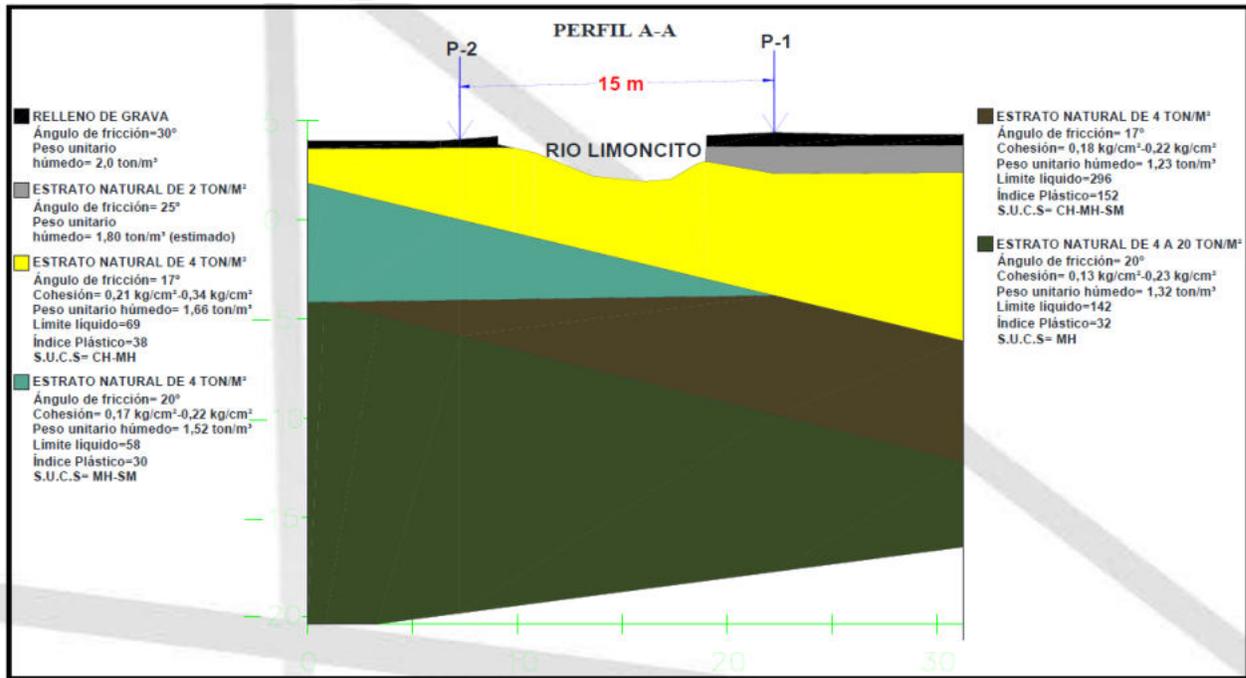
Perfil estratigráfico del sitio Puente Ceibón.
